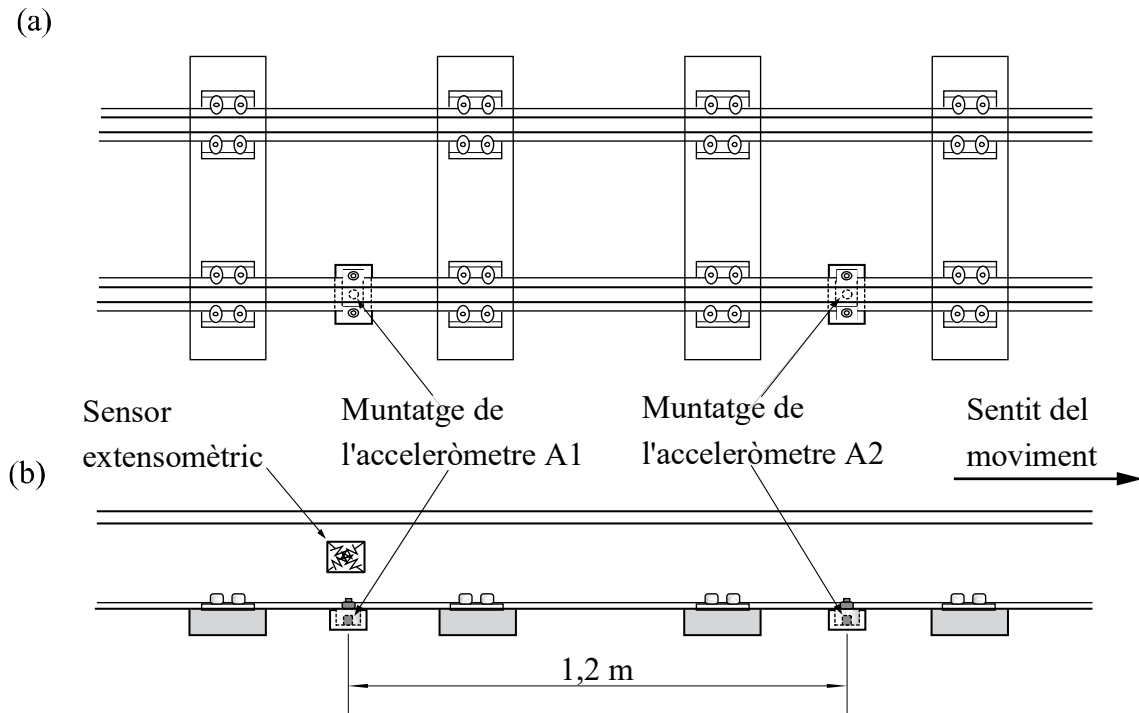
Muntatge de transductors sobre la via, (a) vista en planta, (b) vista de perfil. [6]
